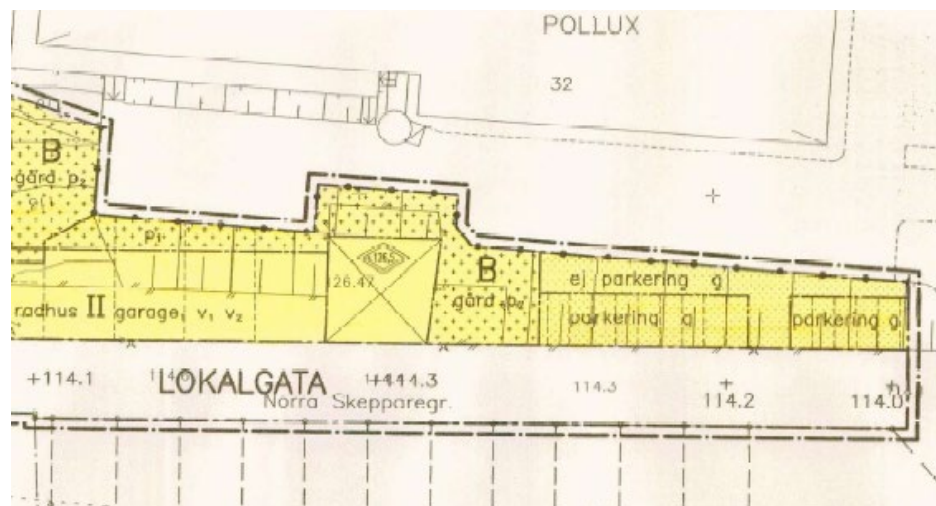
Utsnitt ur gällande detaljplan, Dp 635, som omfattar södra delen av planområdet.
